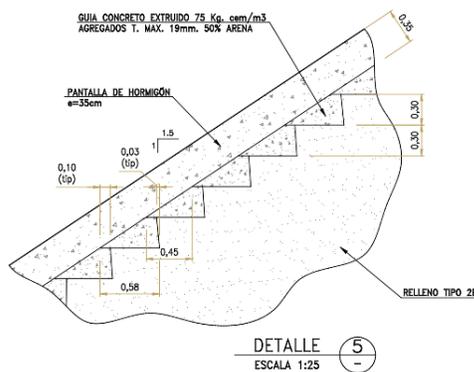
Plano Muro Principal, Detalle Pantalla de Hormigón.
